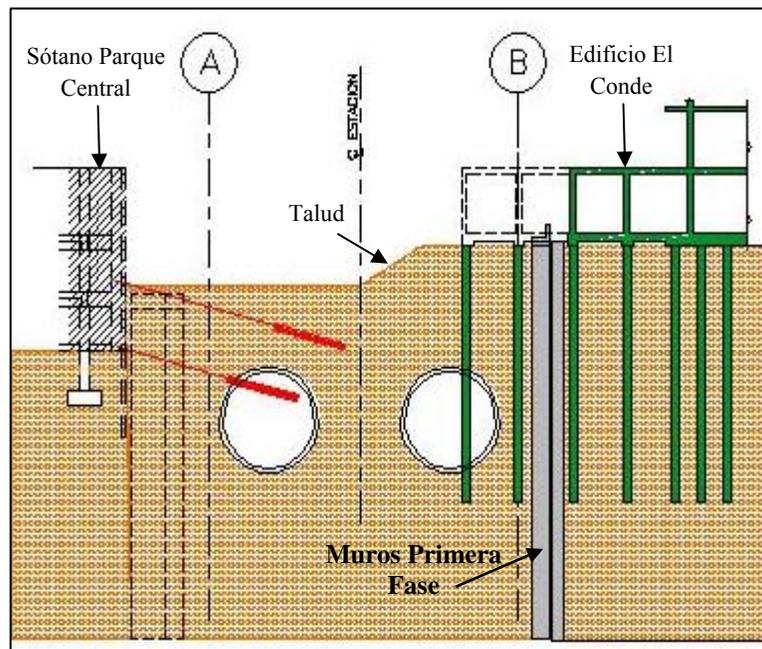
Planta de ejecución de primera fase de muros colados y tablero.
